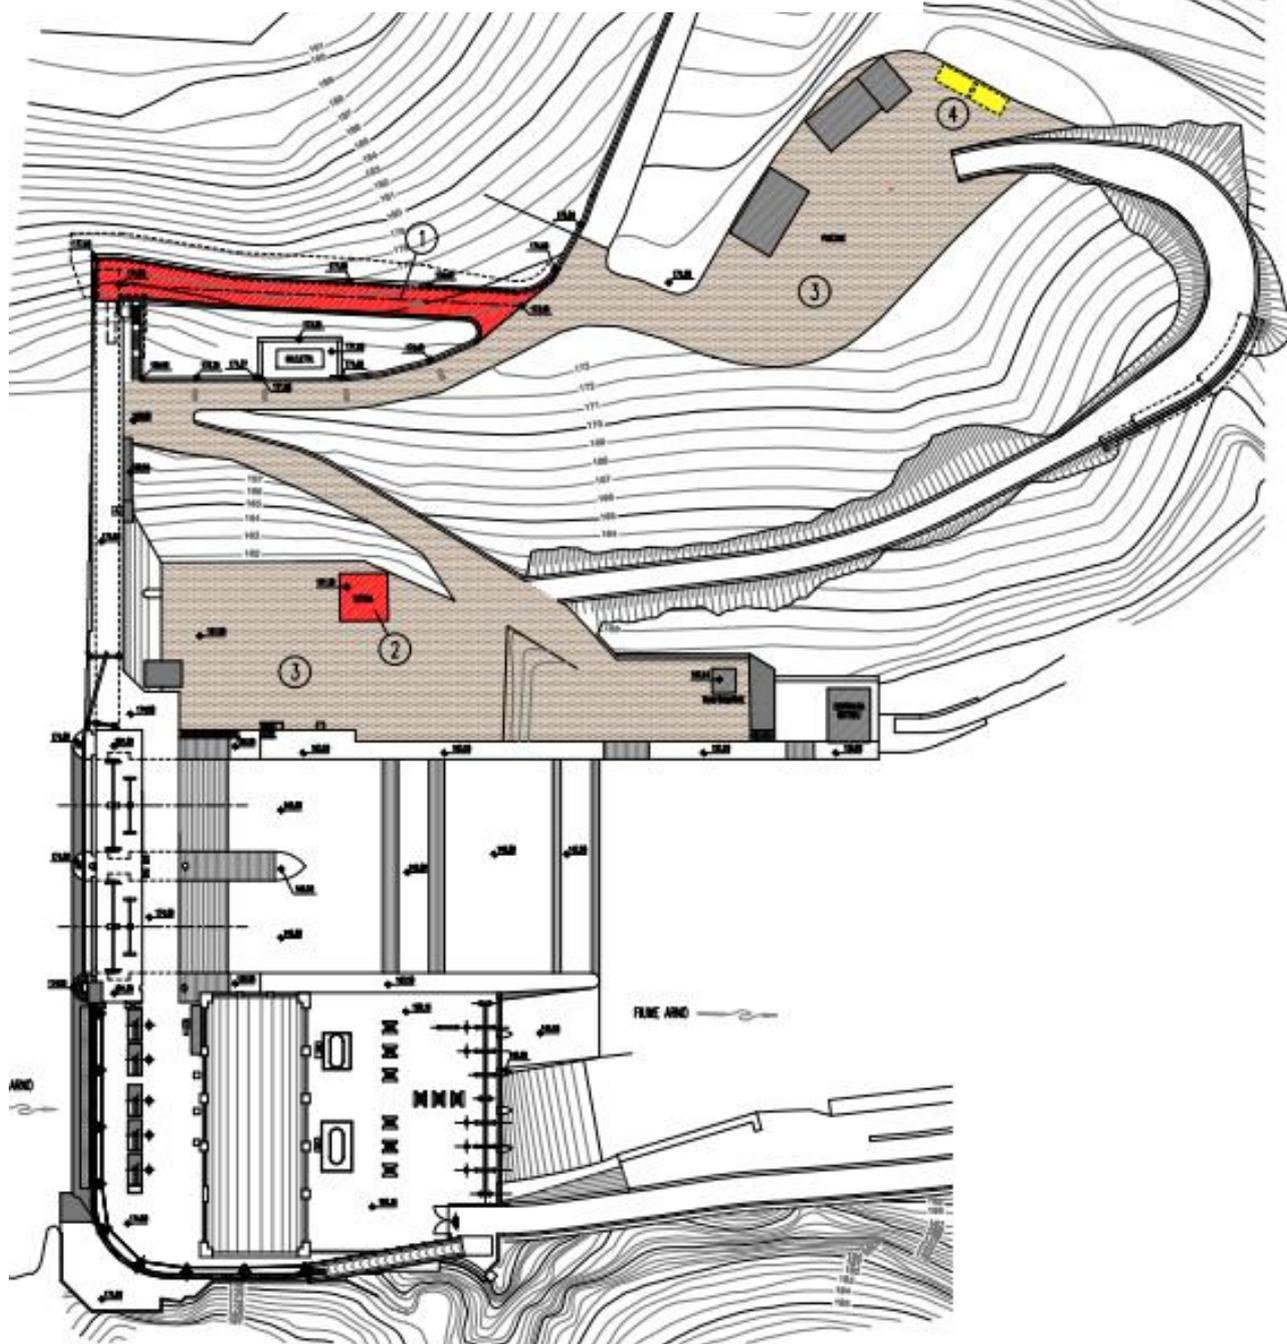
6 – Estratto planimetrico elaborato progettuale – Cantierizzazione FASE 4c
